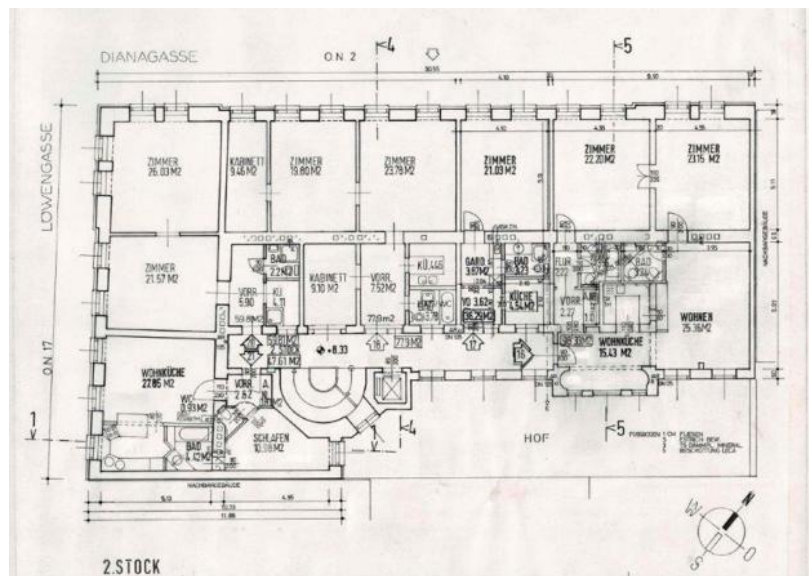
Verwendeter Grundriss für den Modellaufbau in IDA ICE der Dianagasse. Es wurde der Grundrissplan des 2. Stockwerks verwendet (eigene Darstellung).
